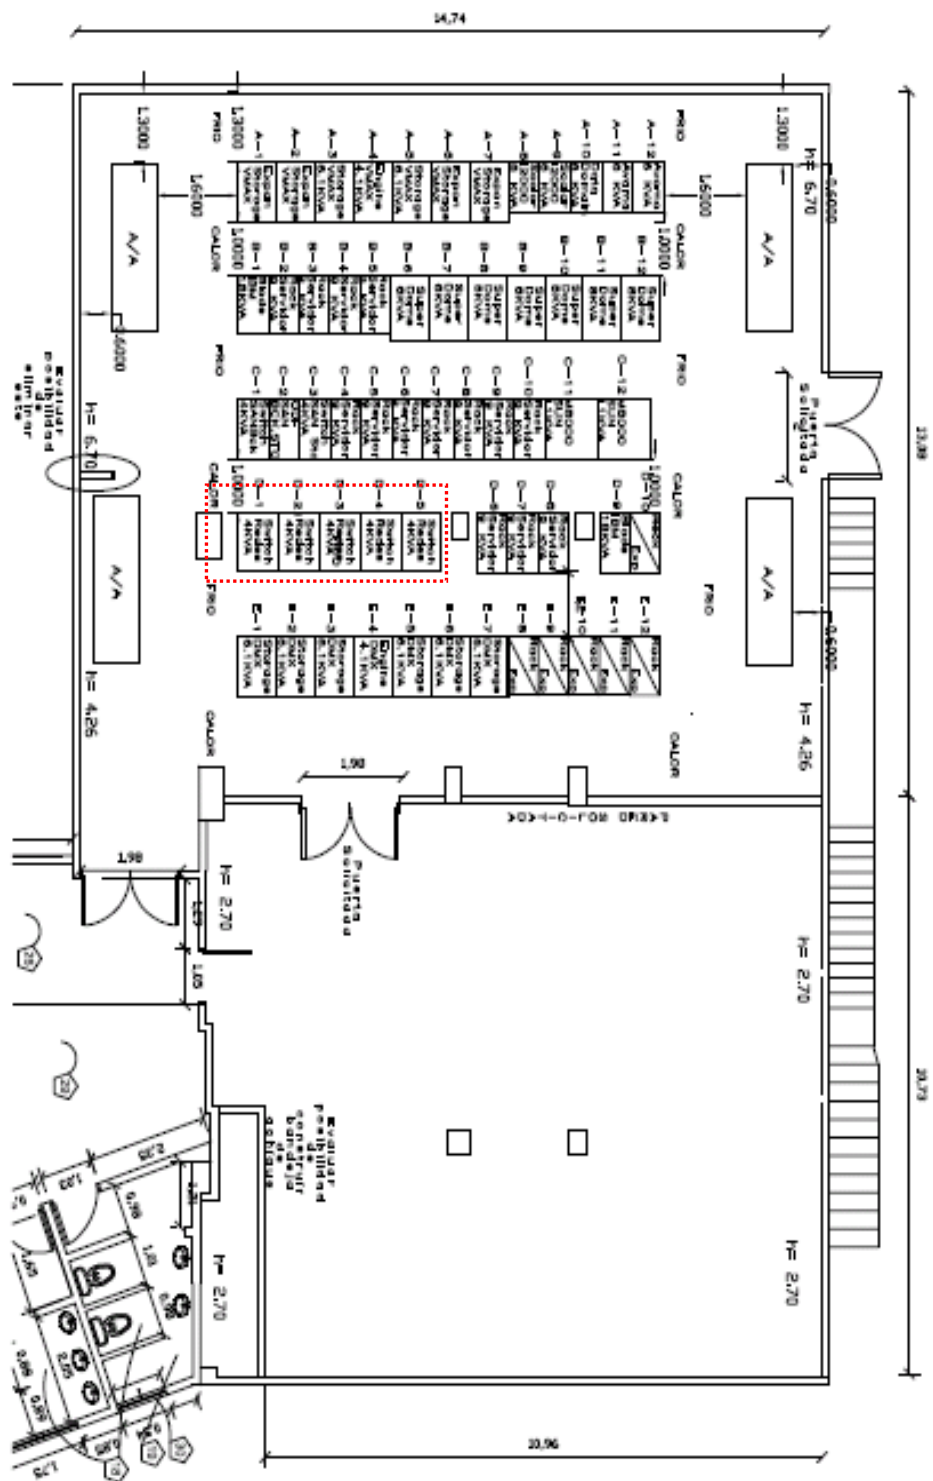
Plano Planta Nivel Piso 1 Centro de Datos La Colina
